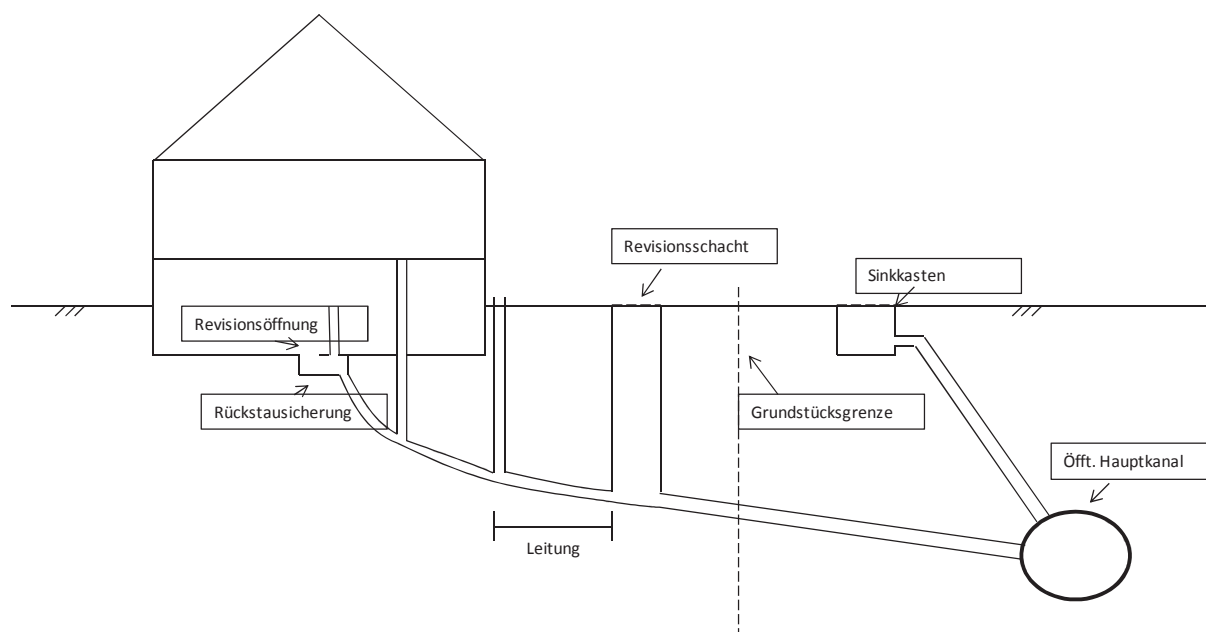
Schematische Darstellung einer Grundstücksentwässerungsanlage mit Anschluss an den öffentlichen Hauptkanal
